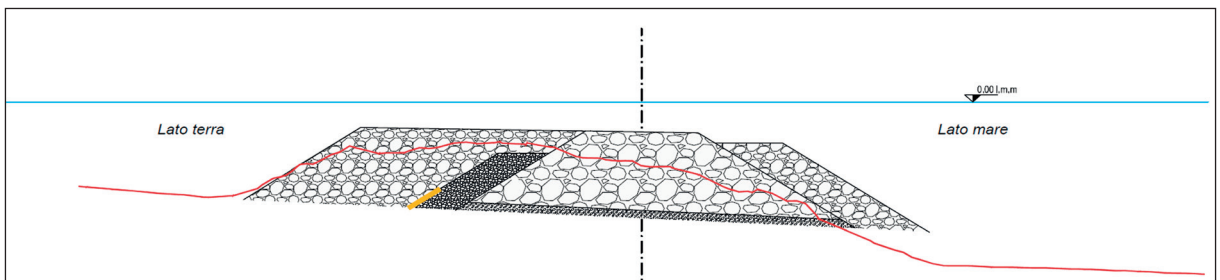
Sezione "tipo 4" della scogliera - Sovrapposizione della sezione di progetto con la sezione di rilievo n. 82.
